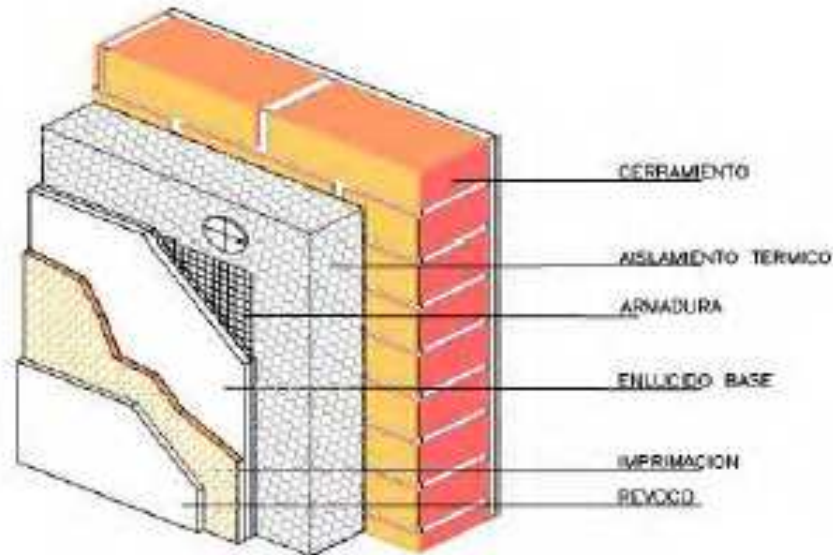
Detalle de sistema SATE para exteriores. Fuente GREEV
